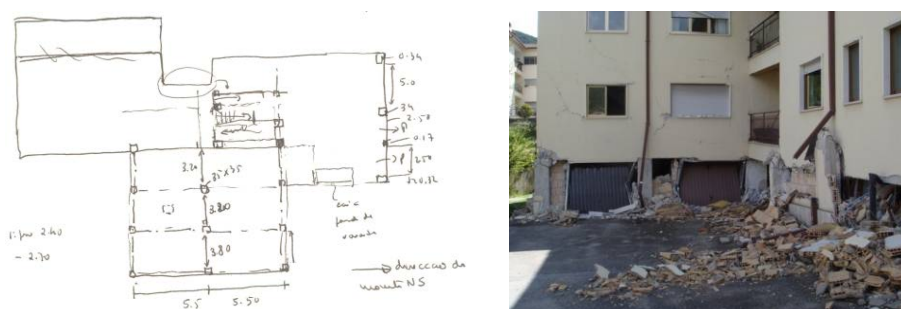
Esquema estrutural da planta e vista geral do edifício PET04
